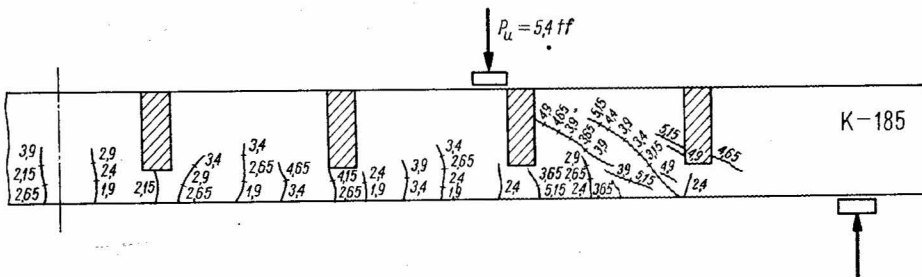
Fissuration de la poutre K-185 sous la charge  $P_u = 5,4$  tf
